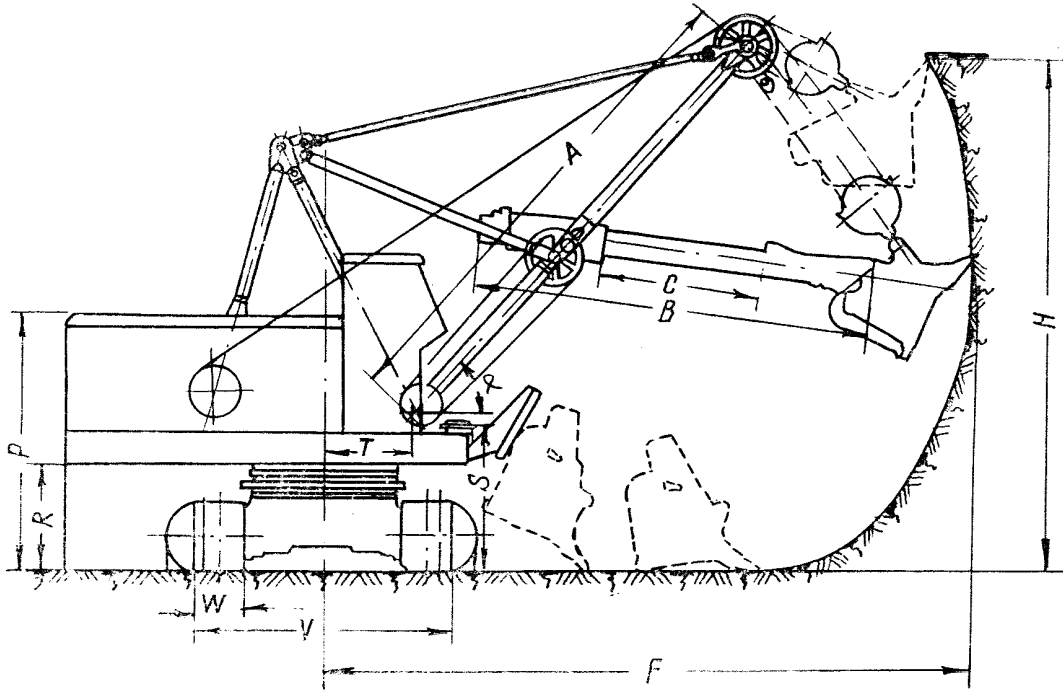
Схема рабочих и габаритных размеров экскаватора ЭКГ-8И
